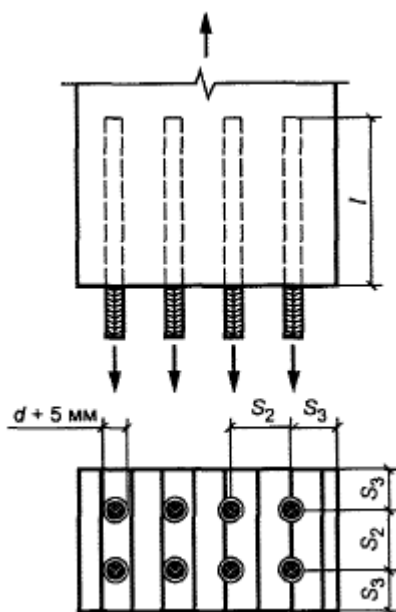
Соединения на стержнях из арматуры периодического профиля, вклеенных вдоль волокон
